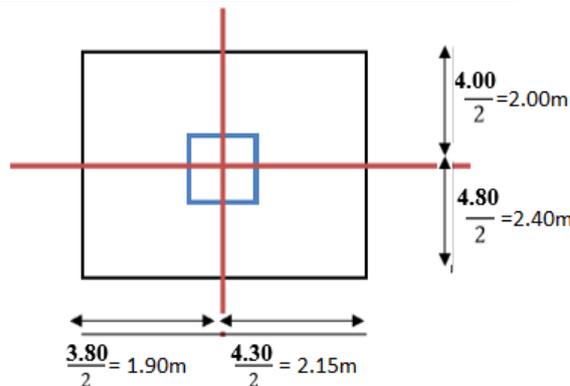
La surface afférente du poteau centre (1^{ème} étage jusqu'au la terrasse)
